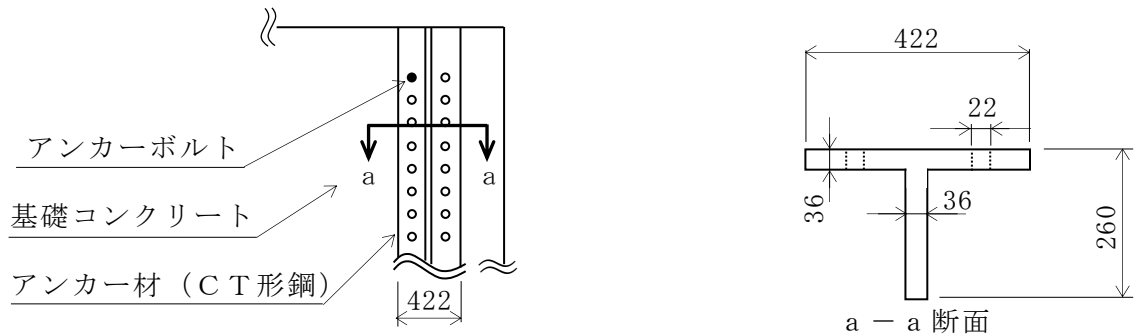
アンカー材（C T形鋼）の概要図（単位：mm）
